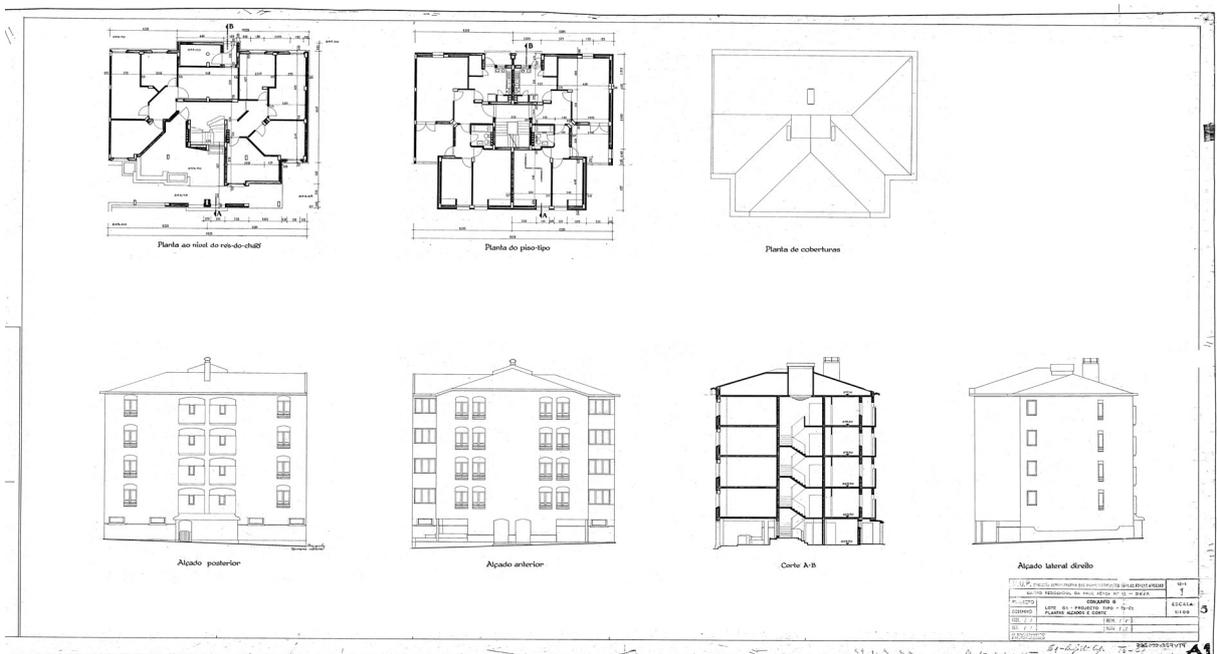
Projeto: lote G1, projecto tipo – T3 – C1, plantas, alçados e corte
